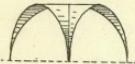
Крестовый сводъ на треугольномъ планѣ.
